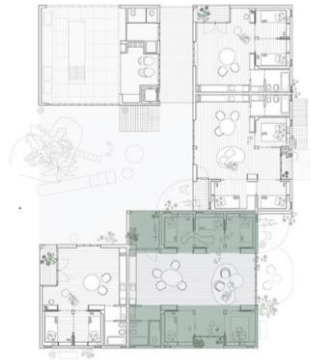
Recorte de la planta del conjunto de vivienda colectiva, indicando en color la herramienta utilizada. Fuente: Elaboración propia.
